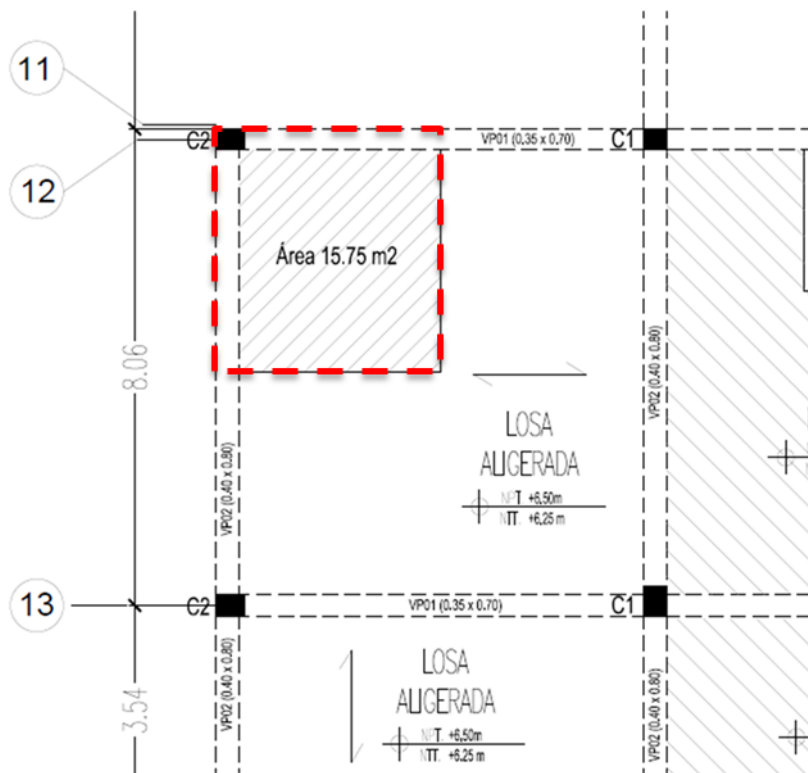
Área de influencia de columna C-1, en el piso 3 y en el techo
